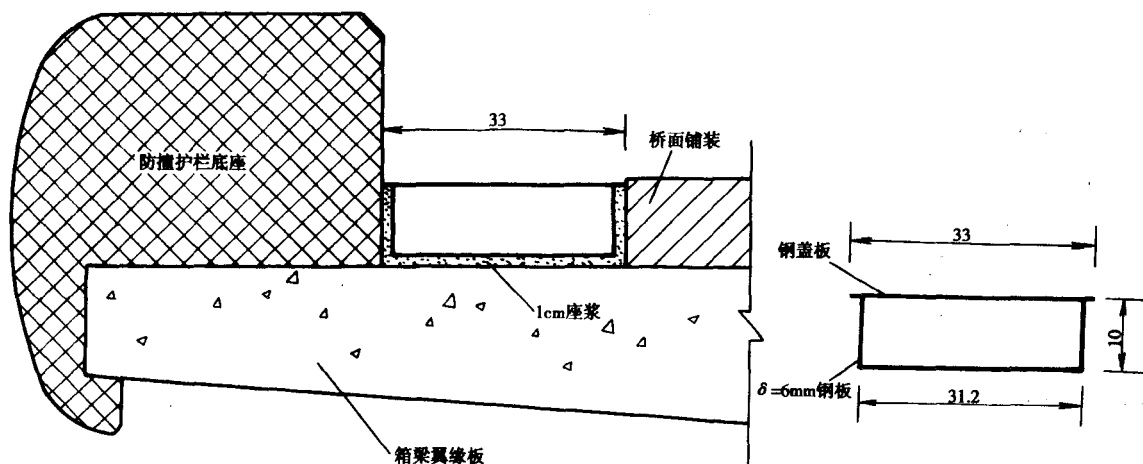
桥面排水槽构造图 (尺寸单位:cm)
